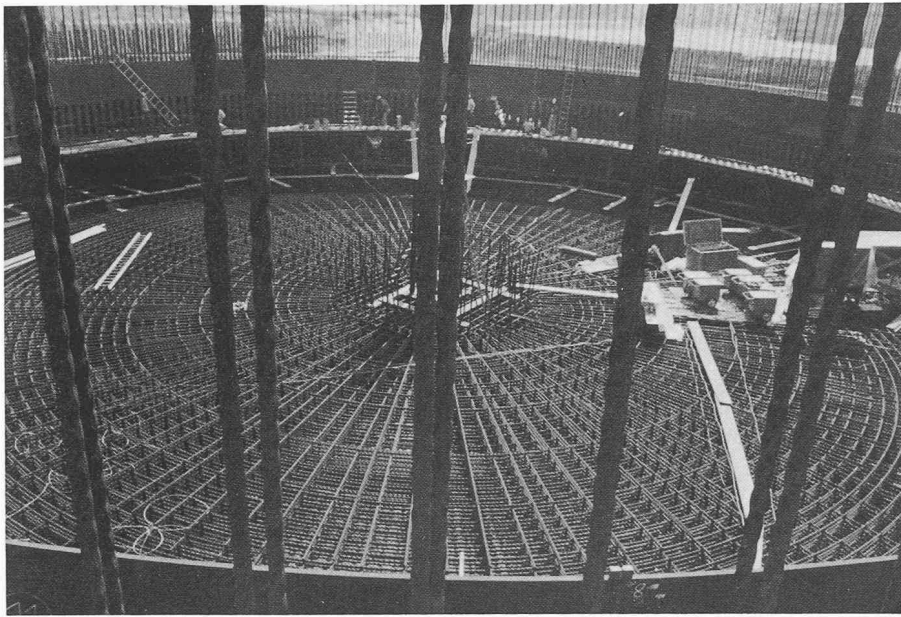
Die untere Bewehrung der Fundamentplatte und die bereits verlegten Verankerungsbleche des Containments und des Drywells
